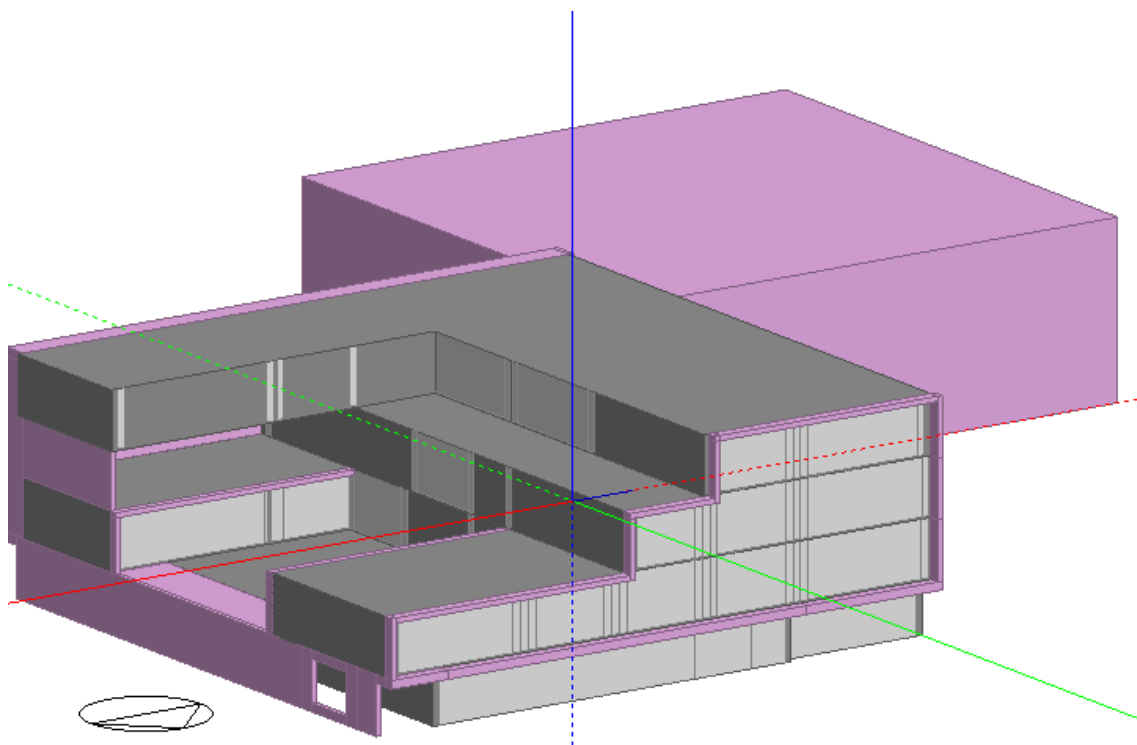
Estructura final exterior de la casa del alumno modelada (Design Builder software , 2015)
